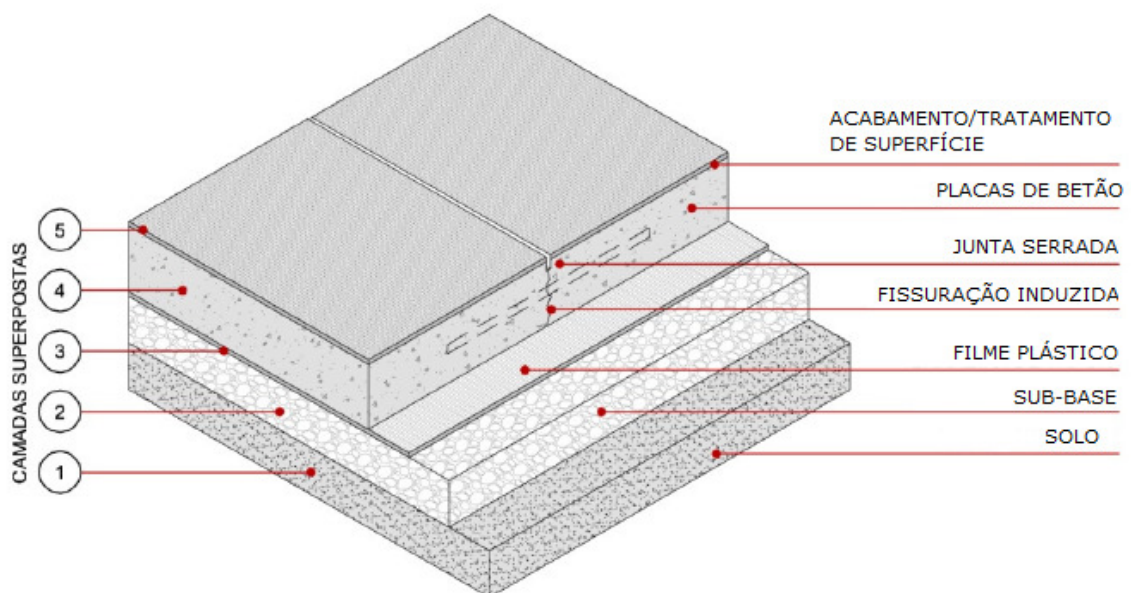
Sistema construtivo de um pavimento industrial (Cristelli, 2010).
